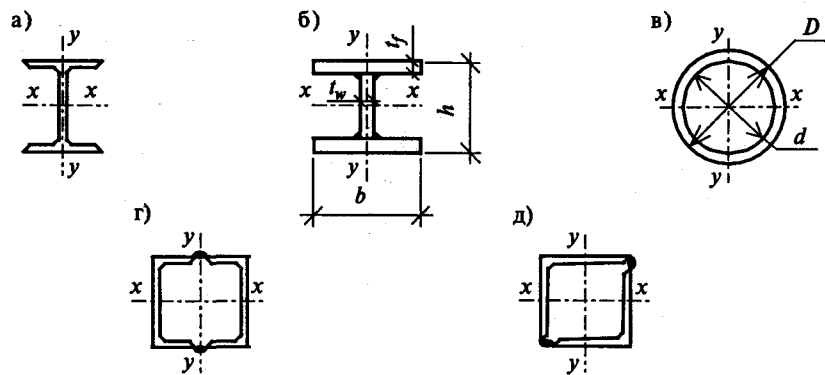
Сечения сплошных колонн: а) прокатный двутавр; б) сварной двутавр; в) труба; г) сечение из двух швеллеров; д) сечение из двух уголков
